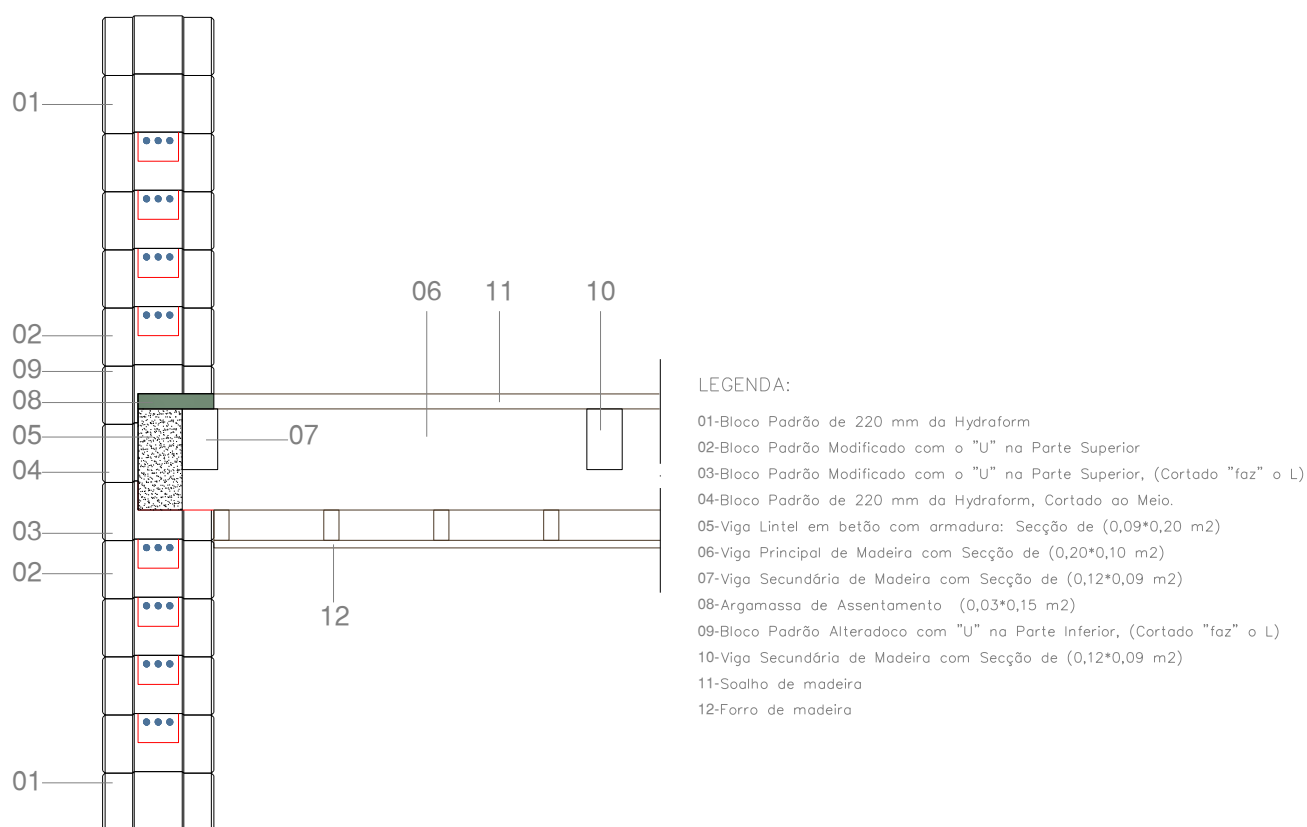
Pormenor de apoio de uma laje intermédia
